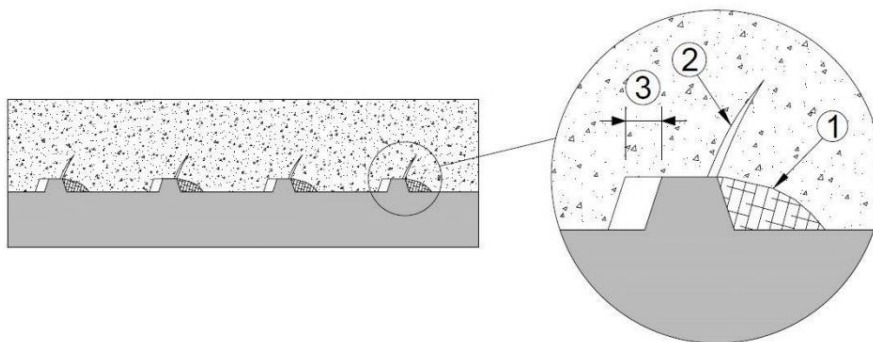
Tipična izvedba reber pri jeklenih armaturnih palicah (Spravljanje betona, 2013)
